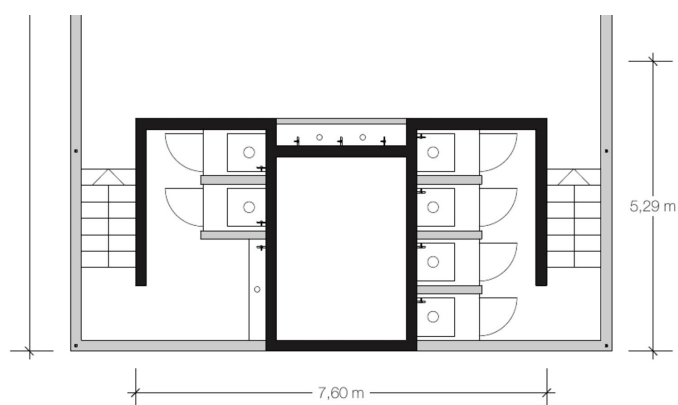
Grundriss Toiletten/Zisternenbereich
